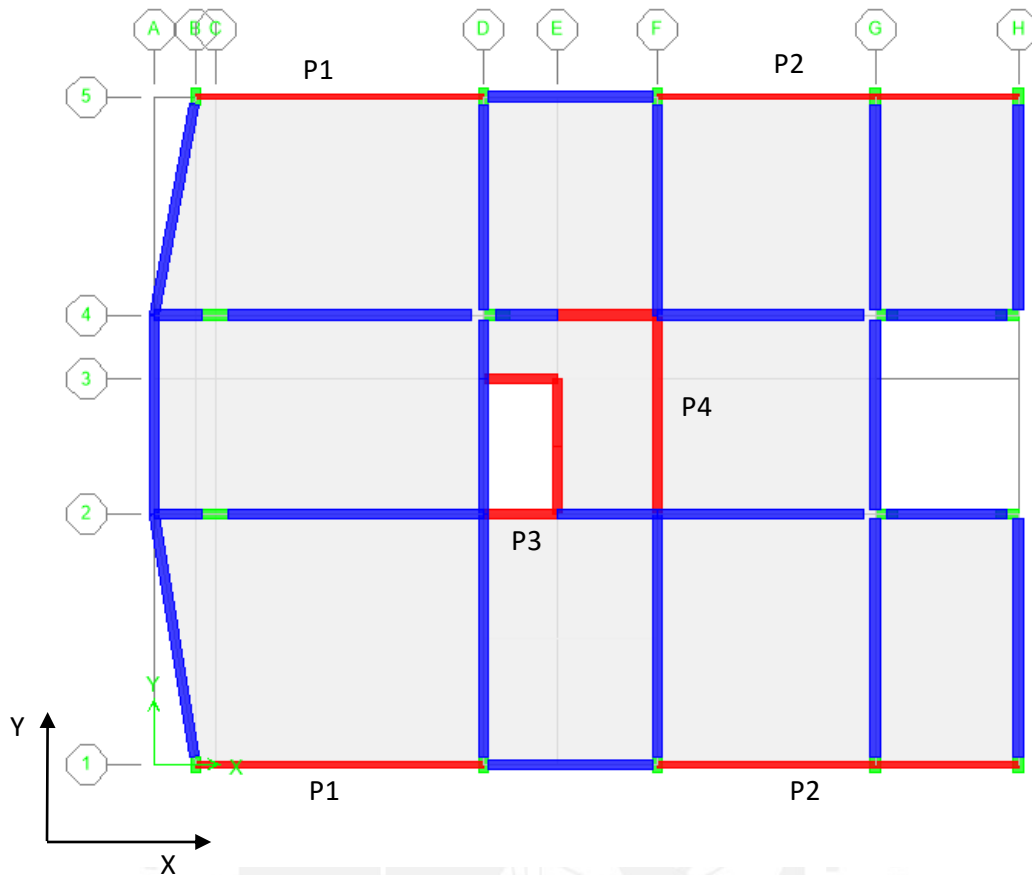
Modelo en Etabs vista en planta (Etabs, 2010)
